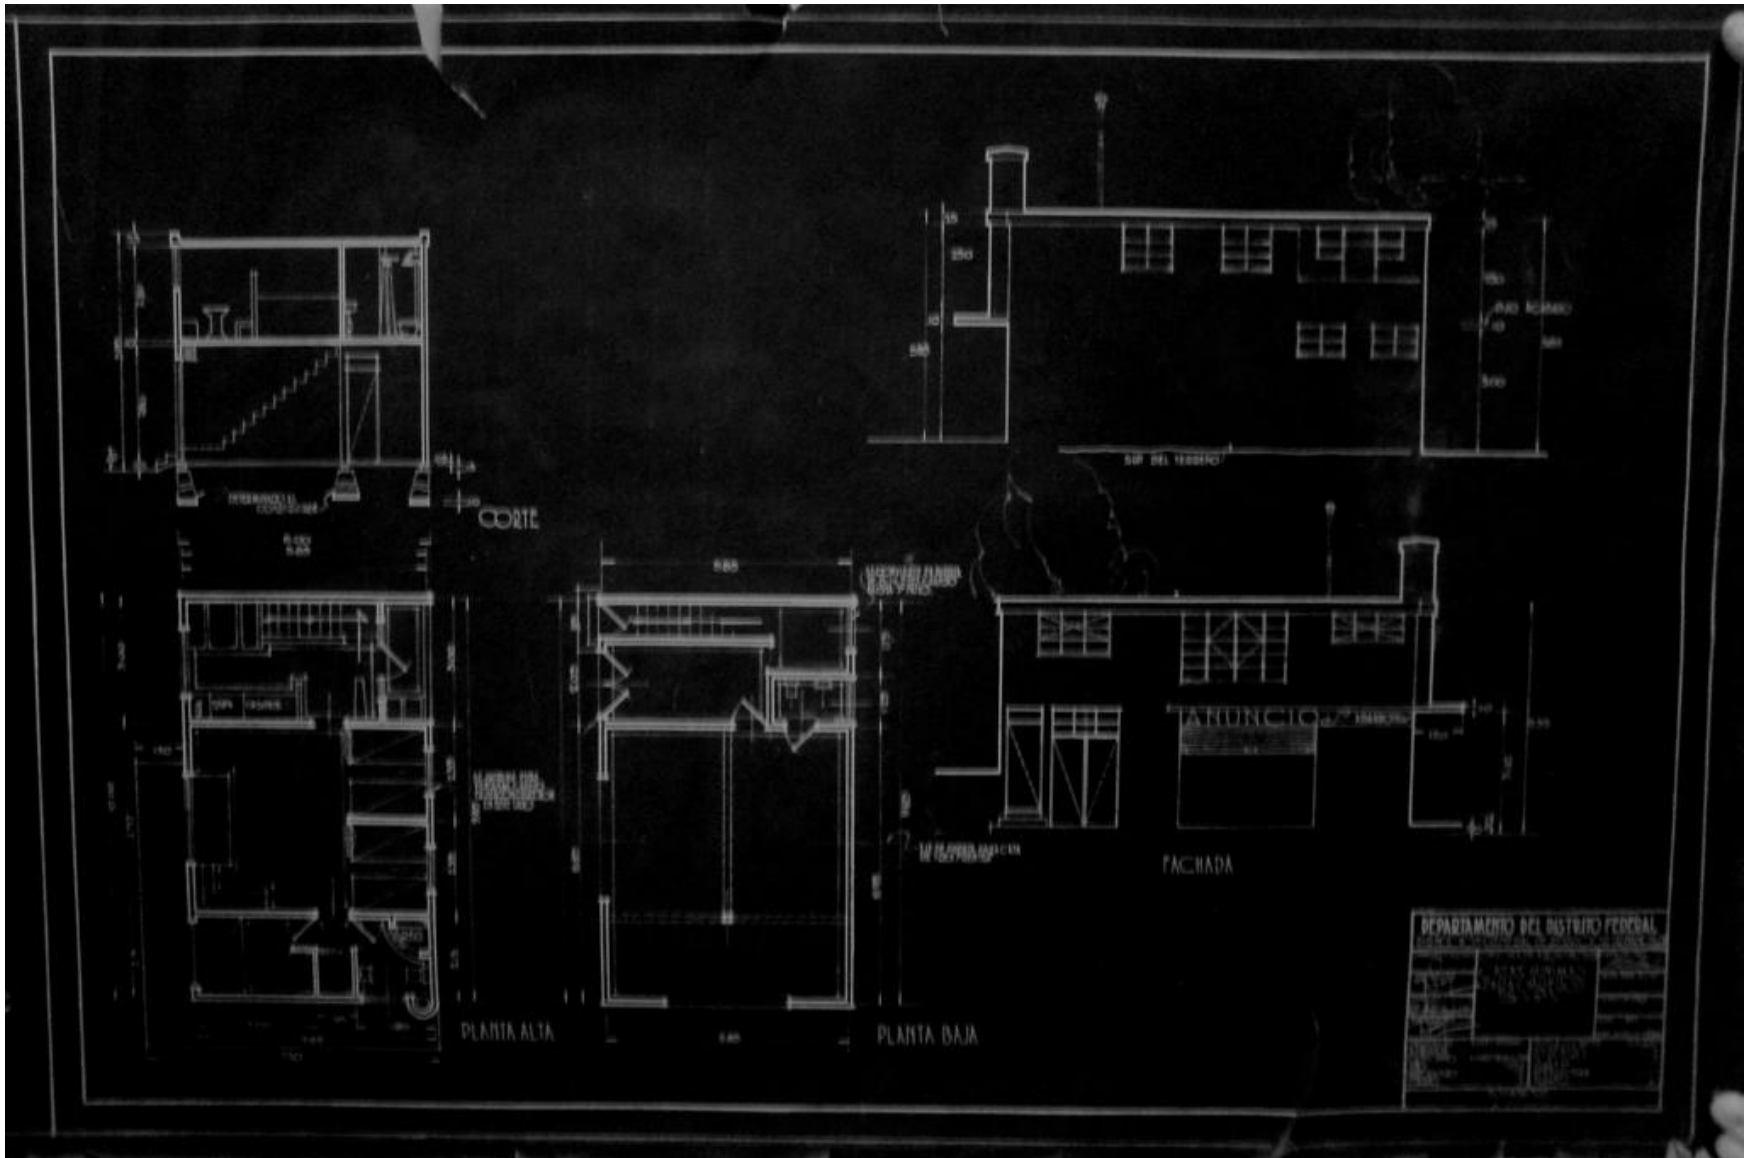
Plano arquitectónico de la Vivienda Tipo Tres de la Unidad Obrera Balbuena.
